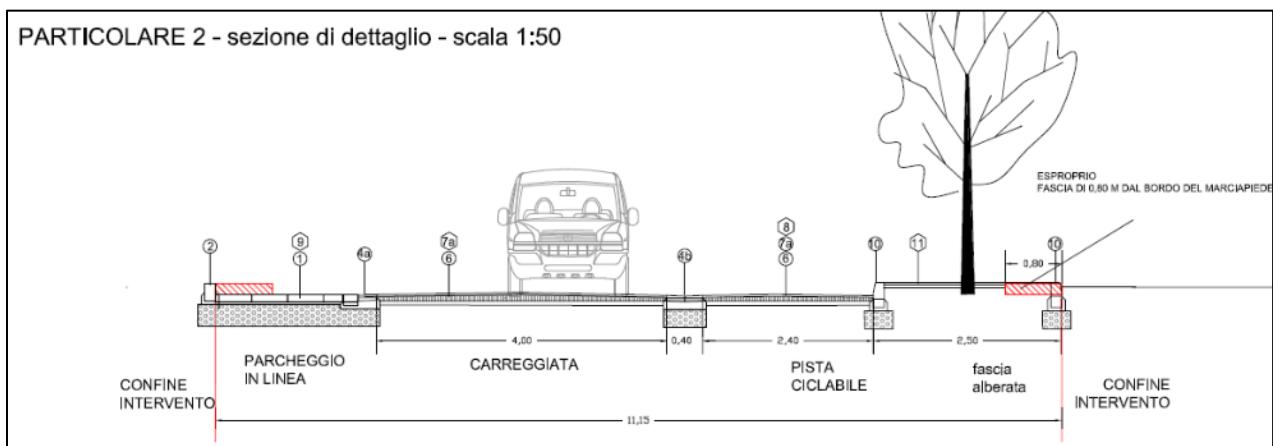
Planimetria e sezione di pavimentazione parcheggi conteggiata come SEMI-PERMEABILE, carreggiata e pista ciclabile come IMPERMEABILI e fascia alberata come PERMEABILE
